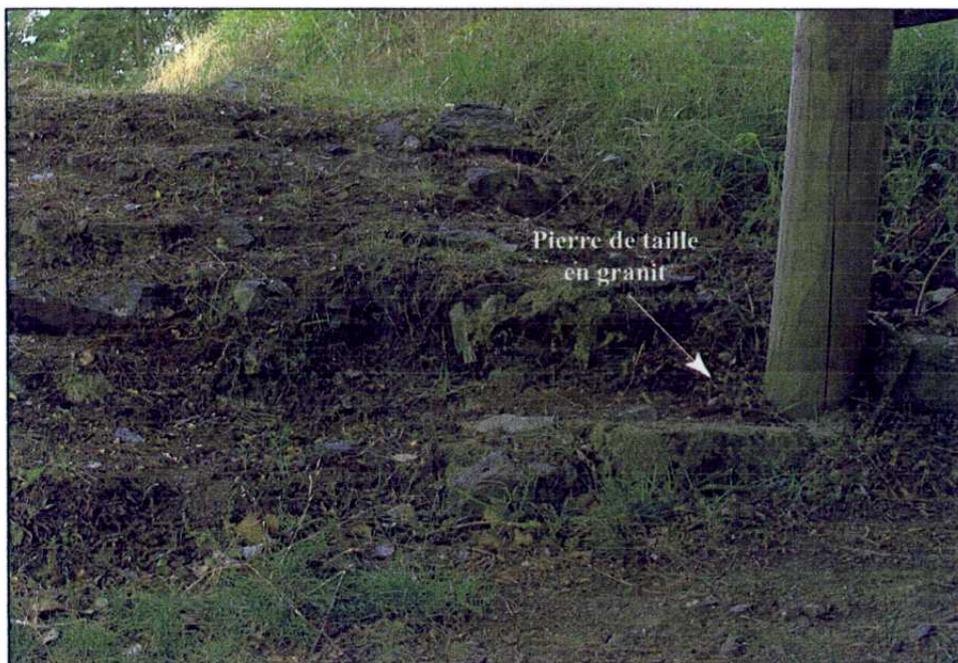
Façade extérieure du mur est. Angle nord-est
